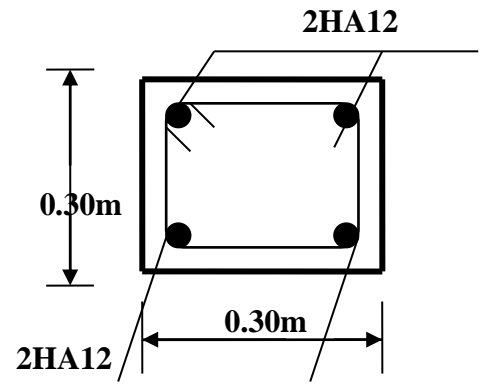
croquée de ferrailage transversal De La poutre palière
